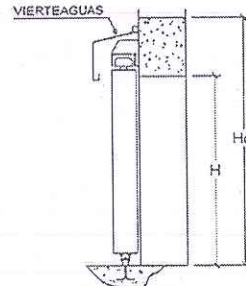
Detalle de sección vertical de puerta industrial corredera apoyada
